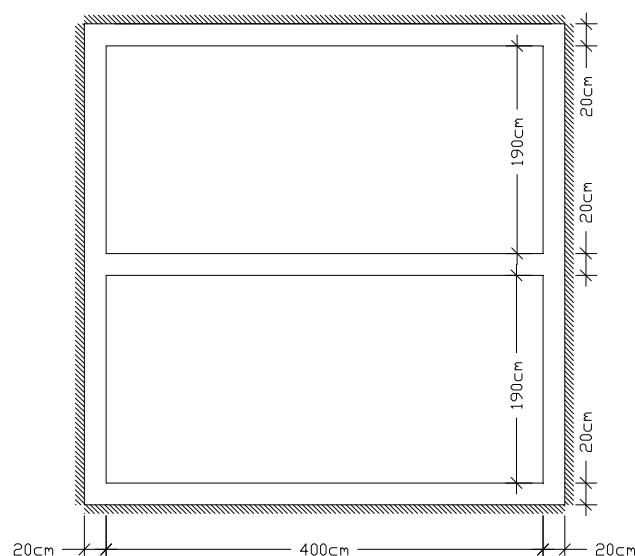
Pavimento Composto por 5 vigas e 2 Lajes
